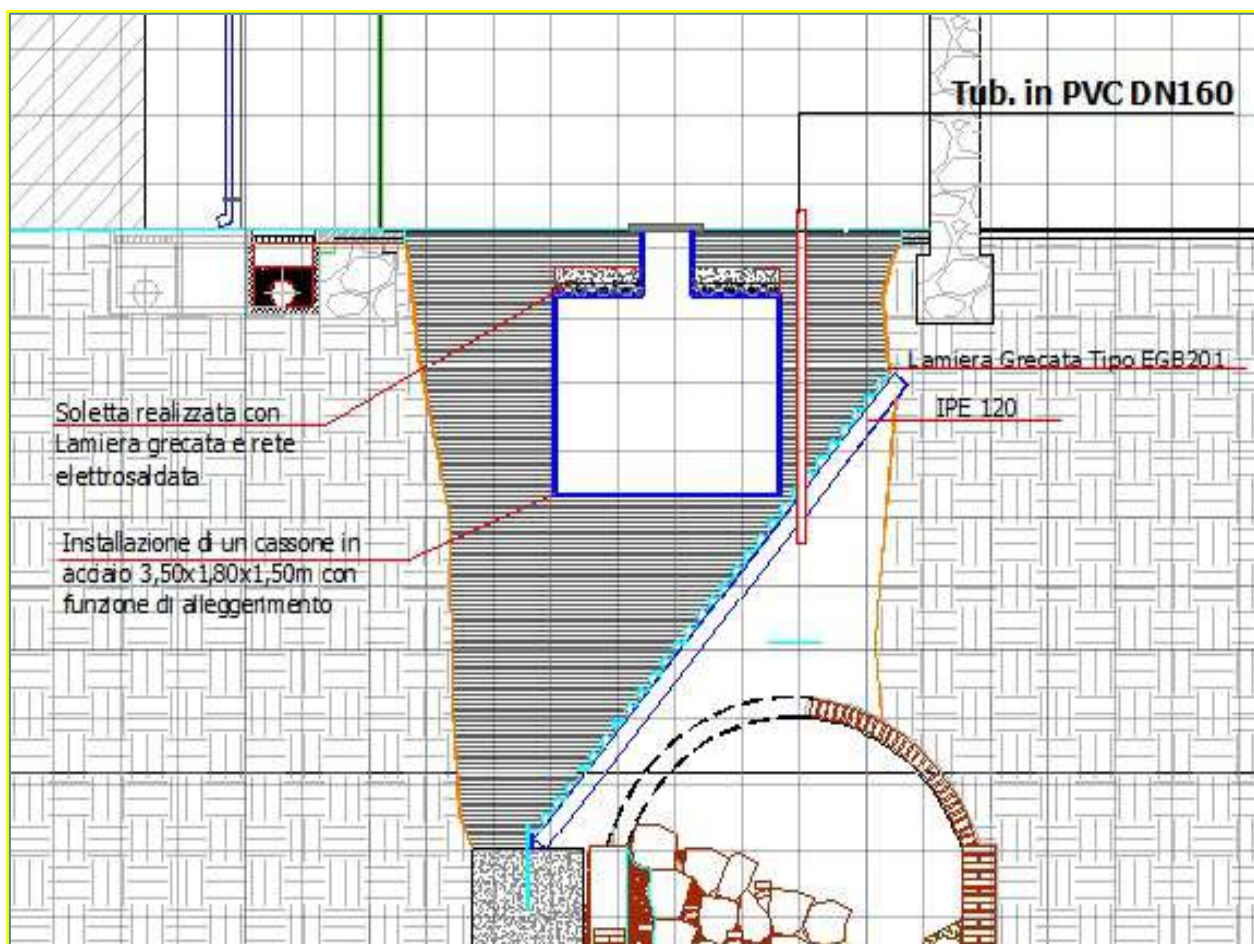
Getto di livellamento con miscela betonabile e successiva installazione del cassone
